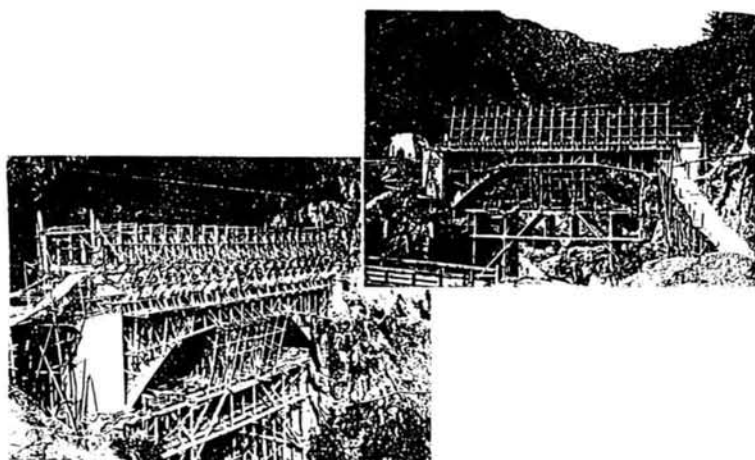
旅足川水路橋、施工状況<sup>48)</sup>
